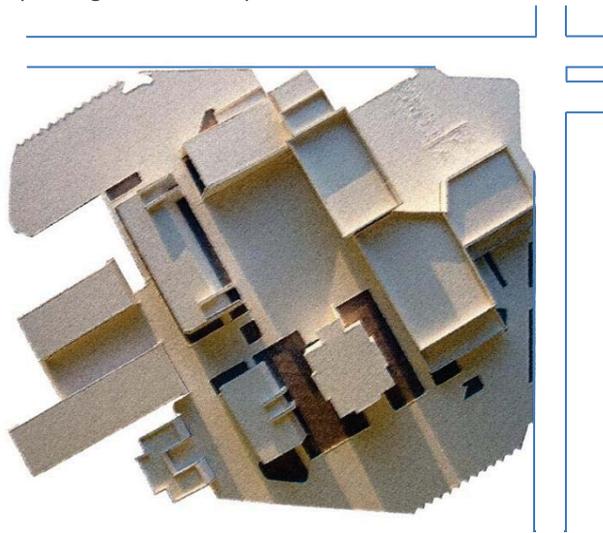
Volúmenes en Planta de Conjunto.
